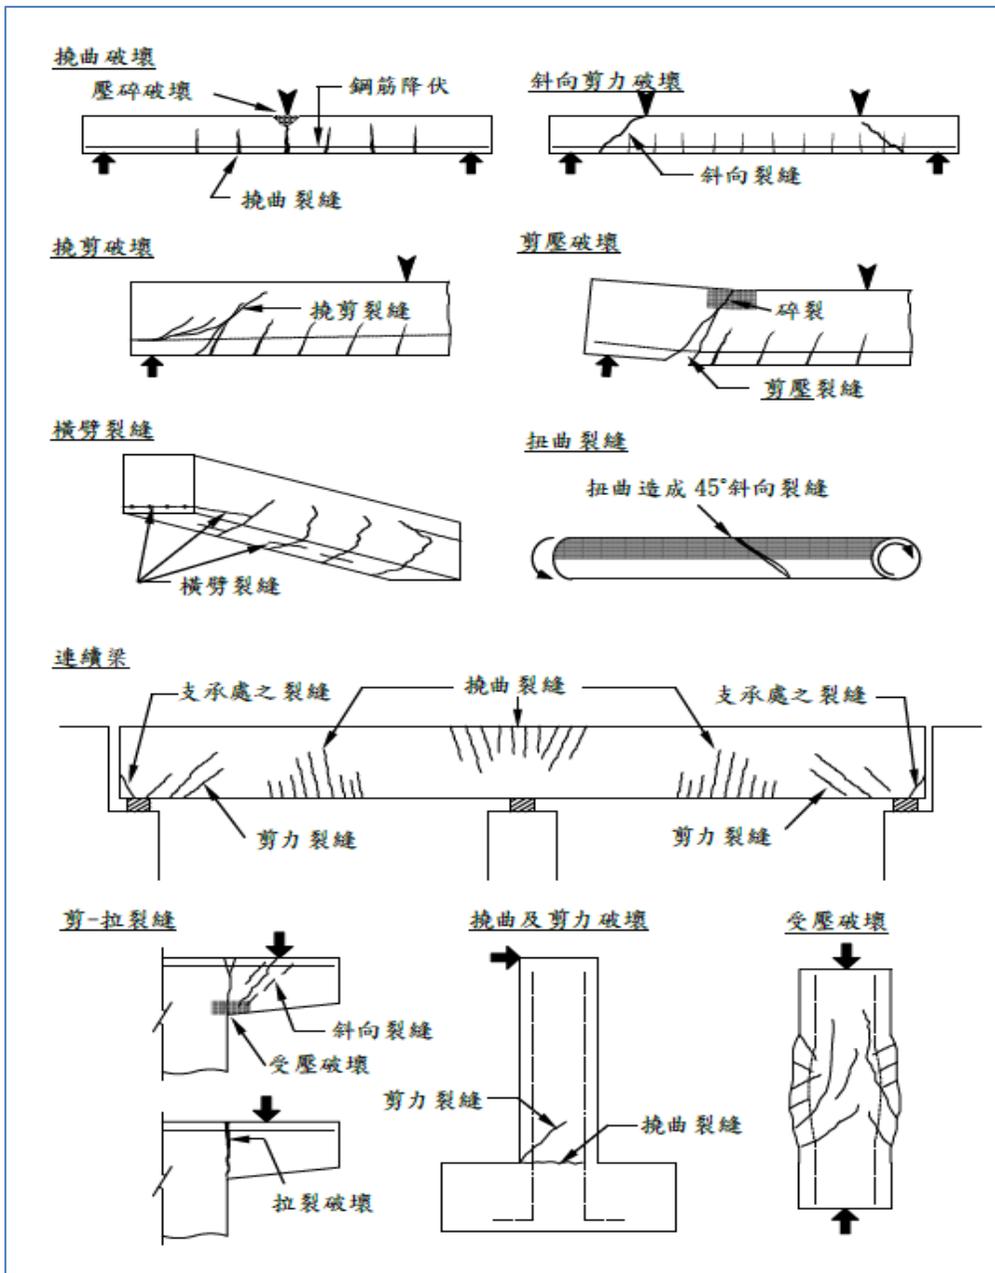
混凝土橋梁主要結構裂縫示意圖
